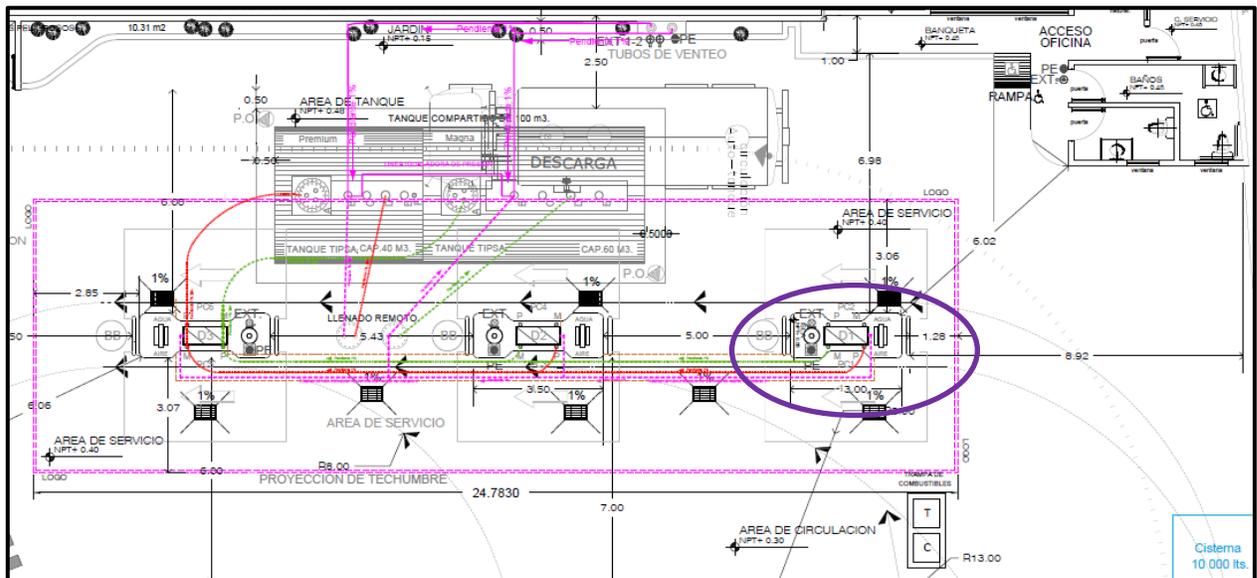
Plano Arquitectónico, área de dispensarios (Estado actual).
